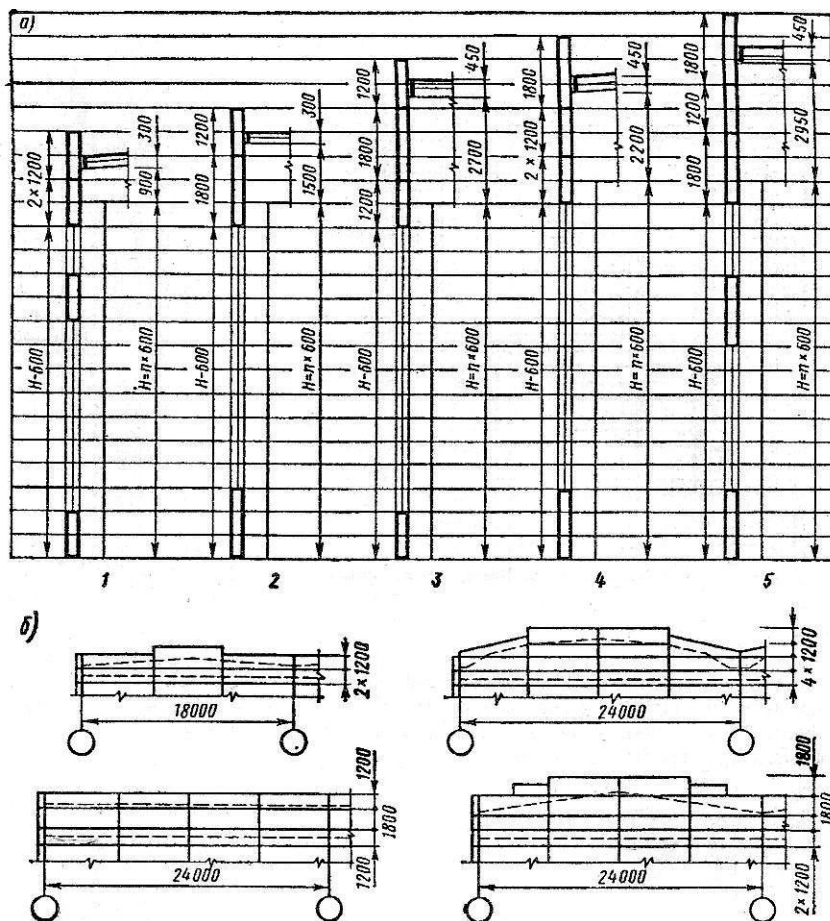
Схемы раскладки панелей в стенах одноэтажных зданий
